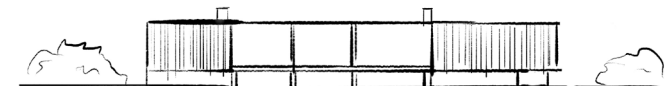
Boceto de un alzado de la Resor House en un contexto de pradera
